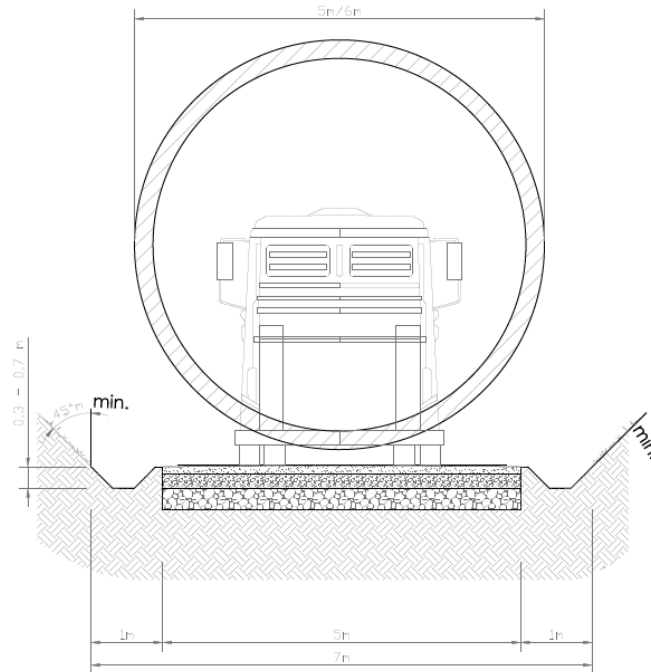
Sezione stradale tipo con rappresentazione dell'ingombro trasporto
